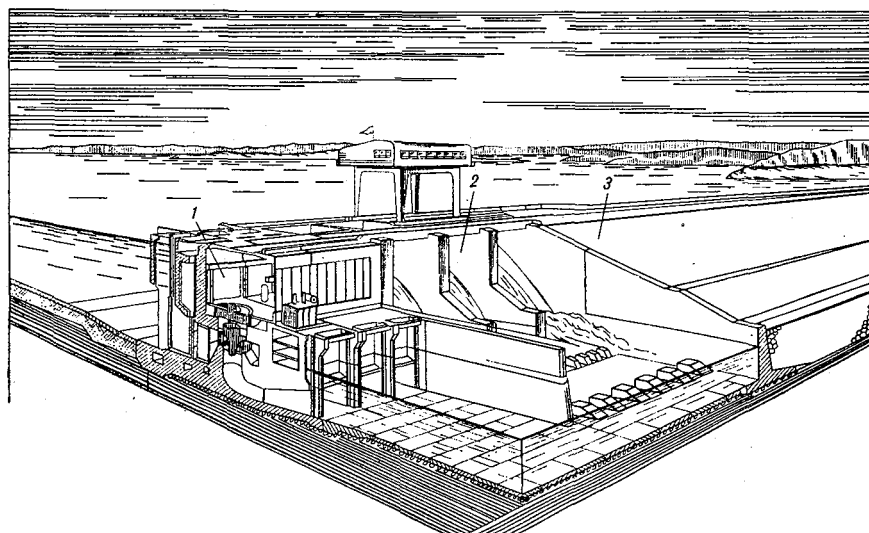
Гидроузел с русловым зданием ГЭС.
